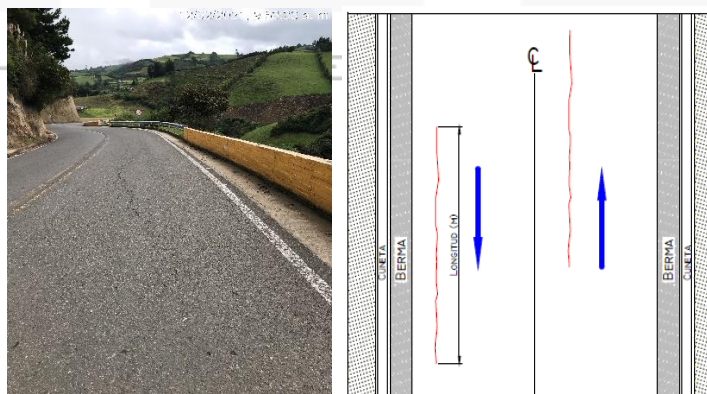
Fisura longitudinal – PR7+650.
